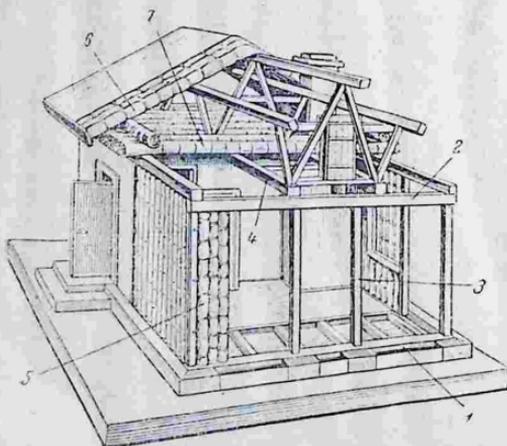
Стены из камышовых фашин: 1—шикля обвязка; 2—верхняя обвязка; 3—стойки; 4—прогон; 5—фашины; 6—кровля из фашин; 7—перекрытие из фашин.
